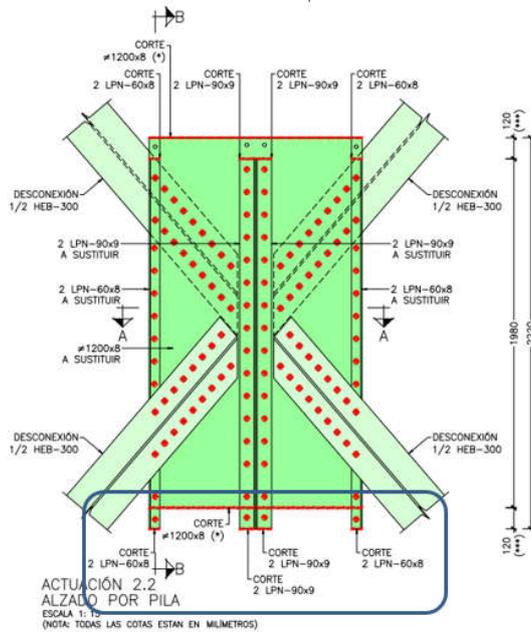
Nudo intermedio mamparo de pila. Corte de chapa de fondo
